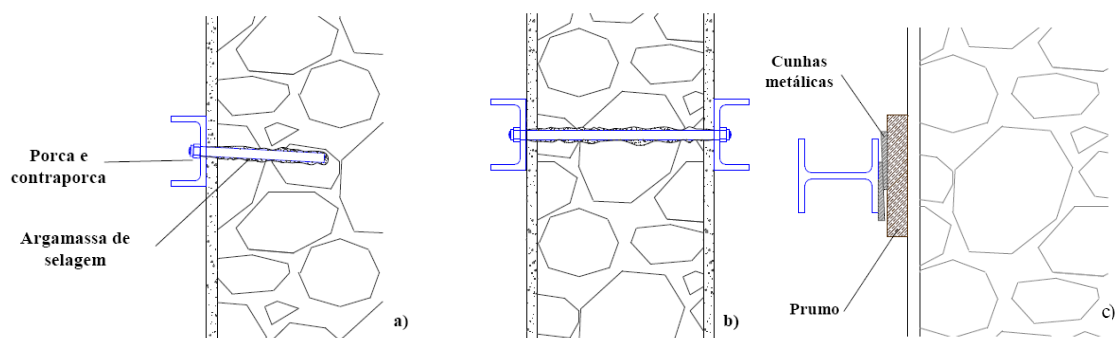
Ligação da estrutura metálica de reforço com a alvenaria (a) – ligação directa parcial; b) – ligação directa total; c) – ligação indirecta (Fonte: Cruz, Rui 2008)
